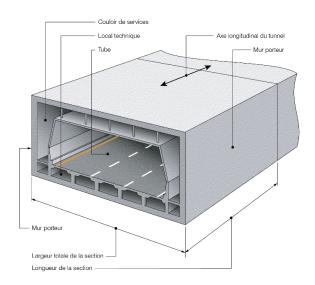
Largeur totale d'une section de tunnel constituée d'un seul tube
